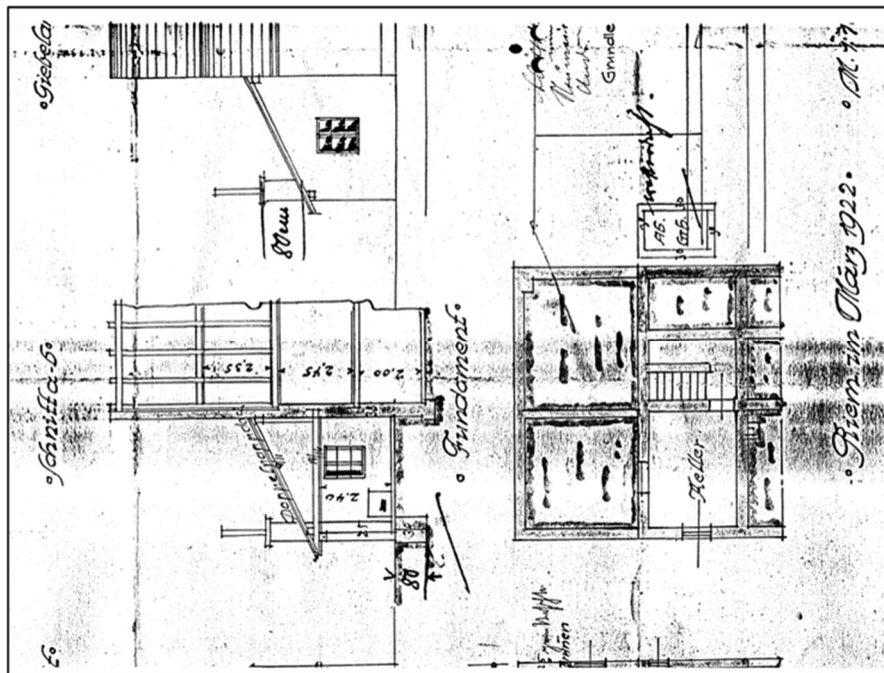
Grundriss (Fundament) des Hauses mit der Zeitangabe „Riem im März 1922“
